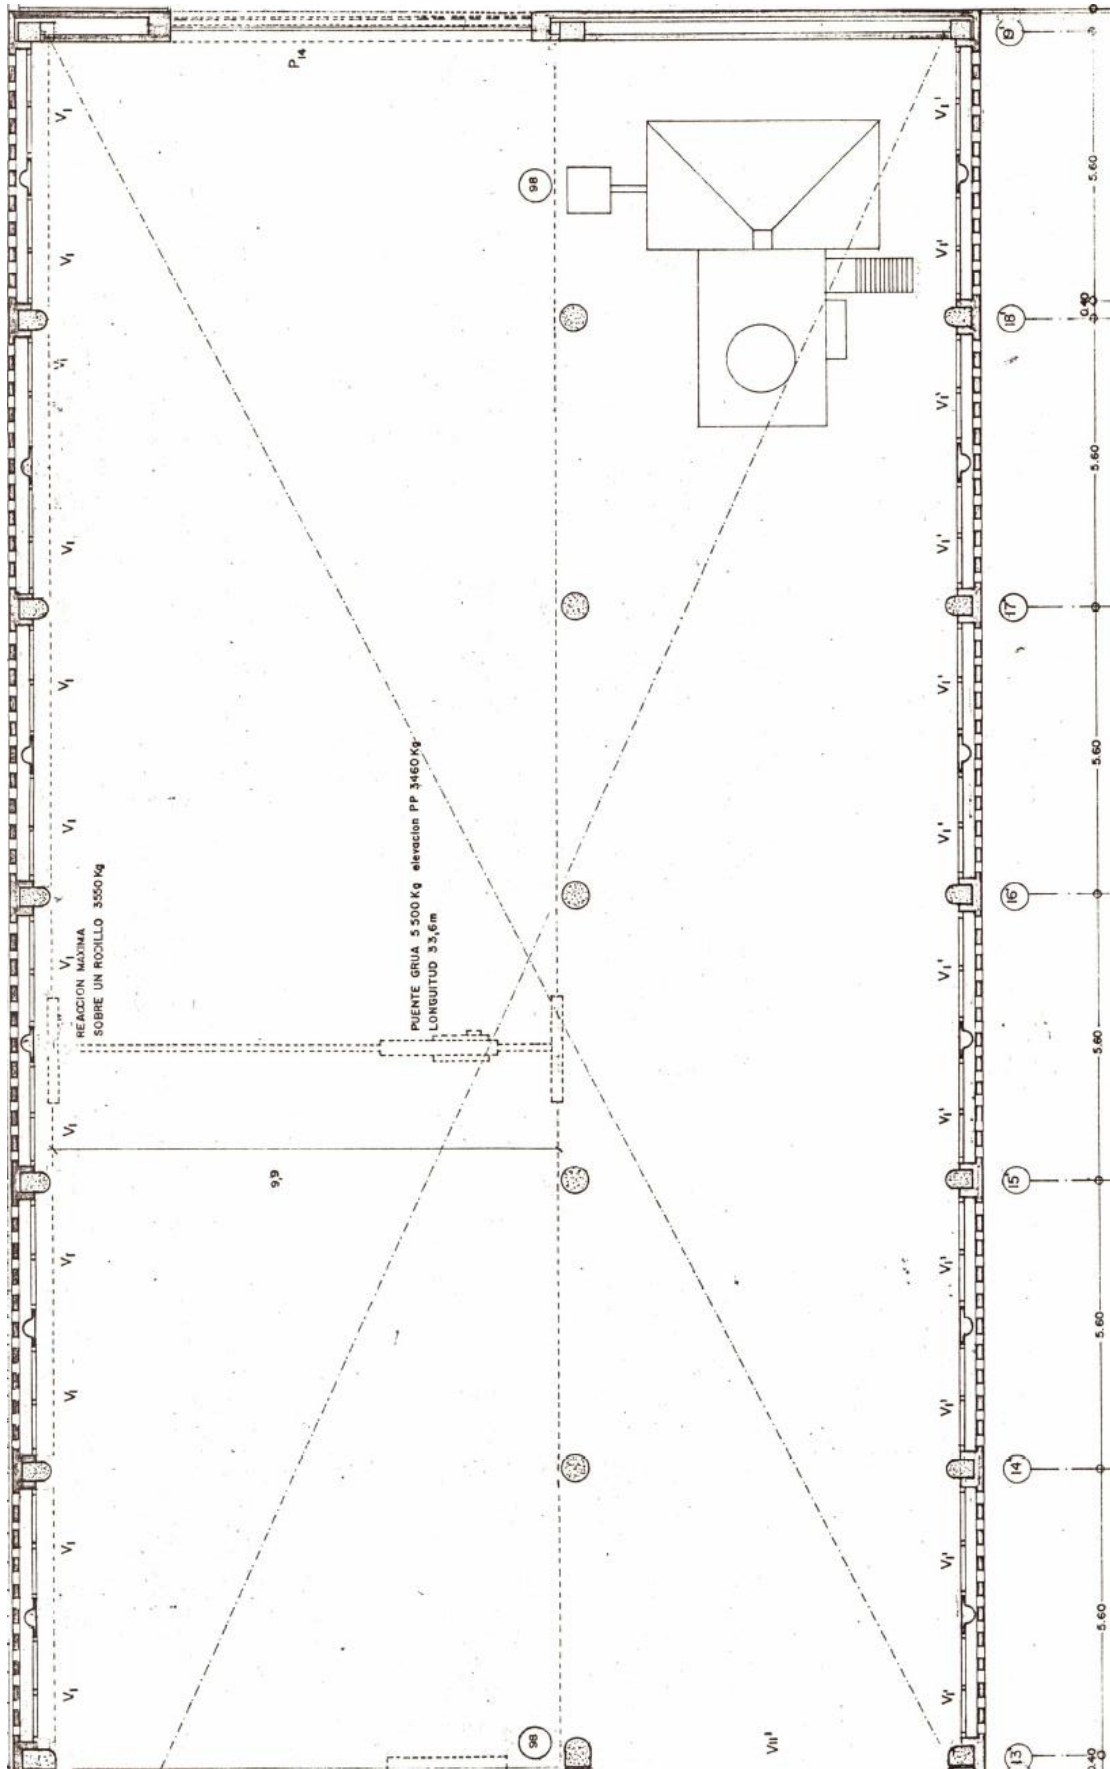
Plano en planta del piso base. (Plano A-5). [1]
